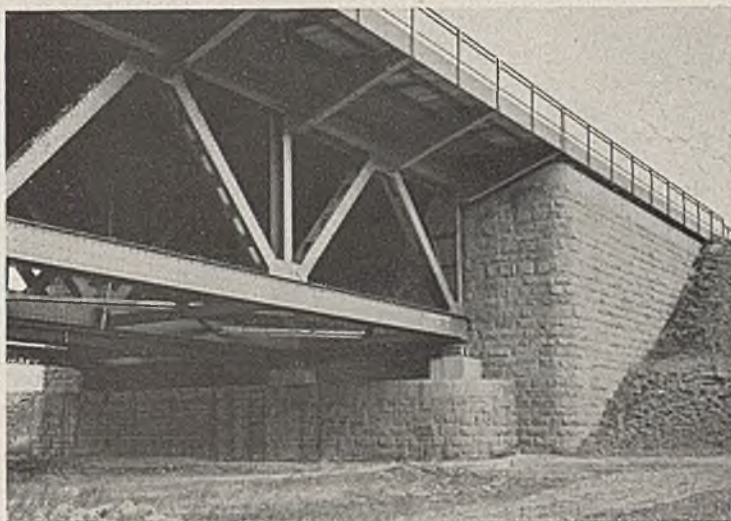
Brücke mit stählernem Fachwerküberbau und mit Widerlagern mit Parallelfügeln.
